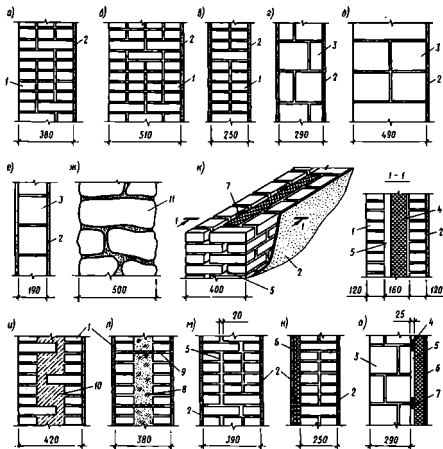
Варианты ручной кладки стен малоэтажных жилых зданий:
